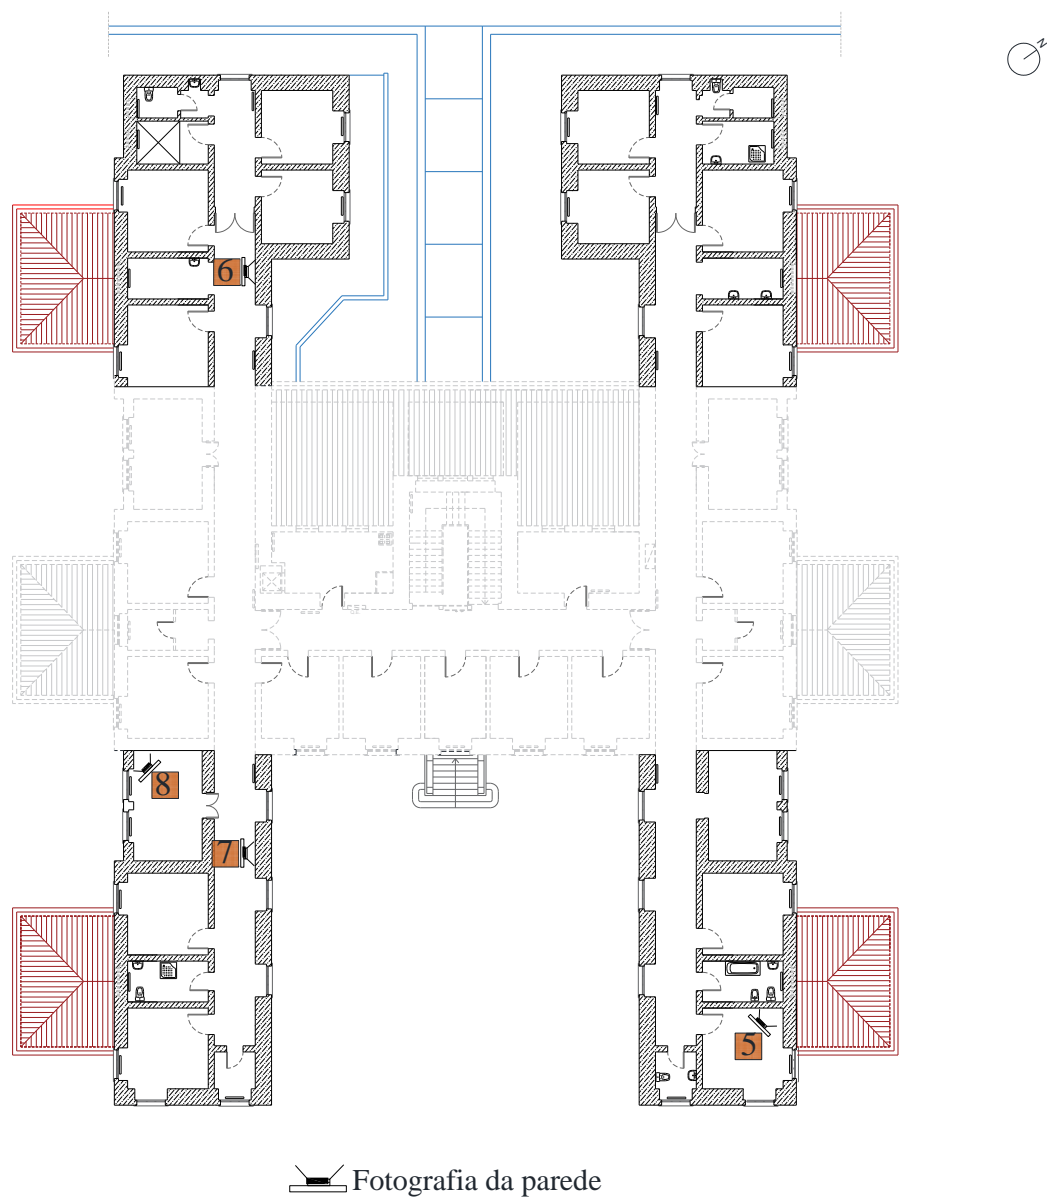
Identificação das Imagens , na planta do Piso 1 [Fonte: Planta cedida pelo C.H.J.M]
